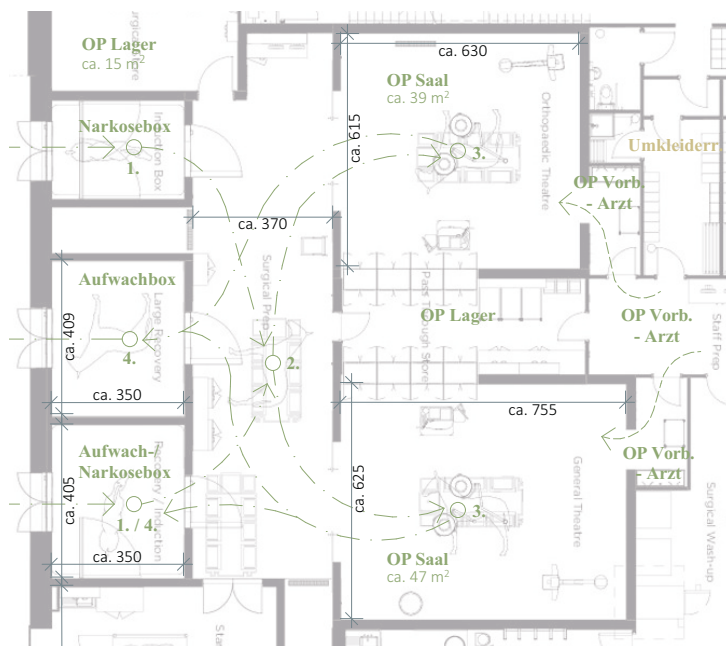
Grundrissausschnitt Erdgeschoß - Horse Hospital (Edinburgh)
